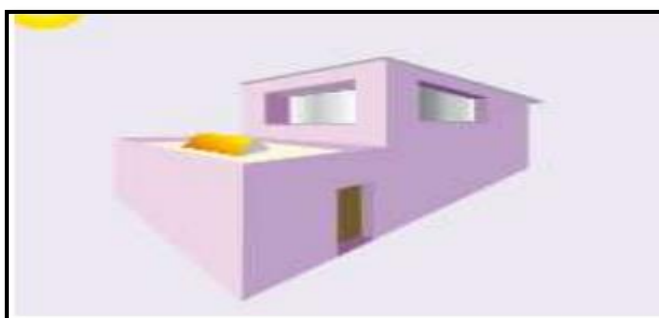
Installation des capteurs solaires sur une toiture terrasse.
